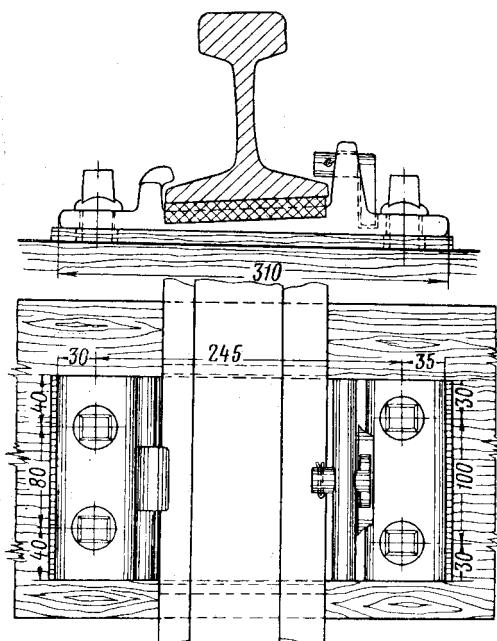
Общий вид промежуточного скрепления раздельного типа
